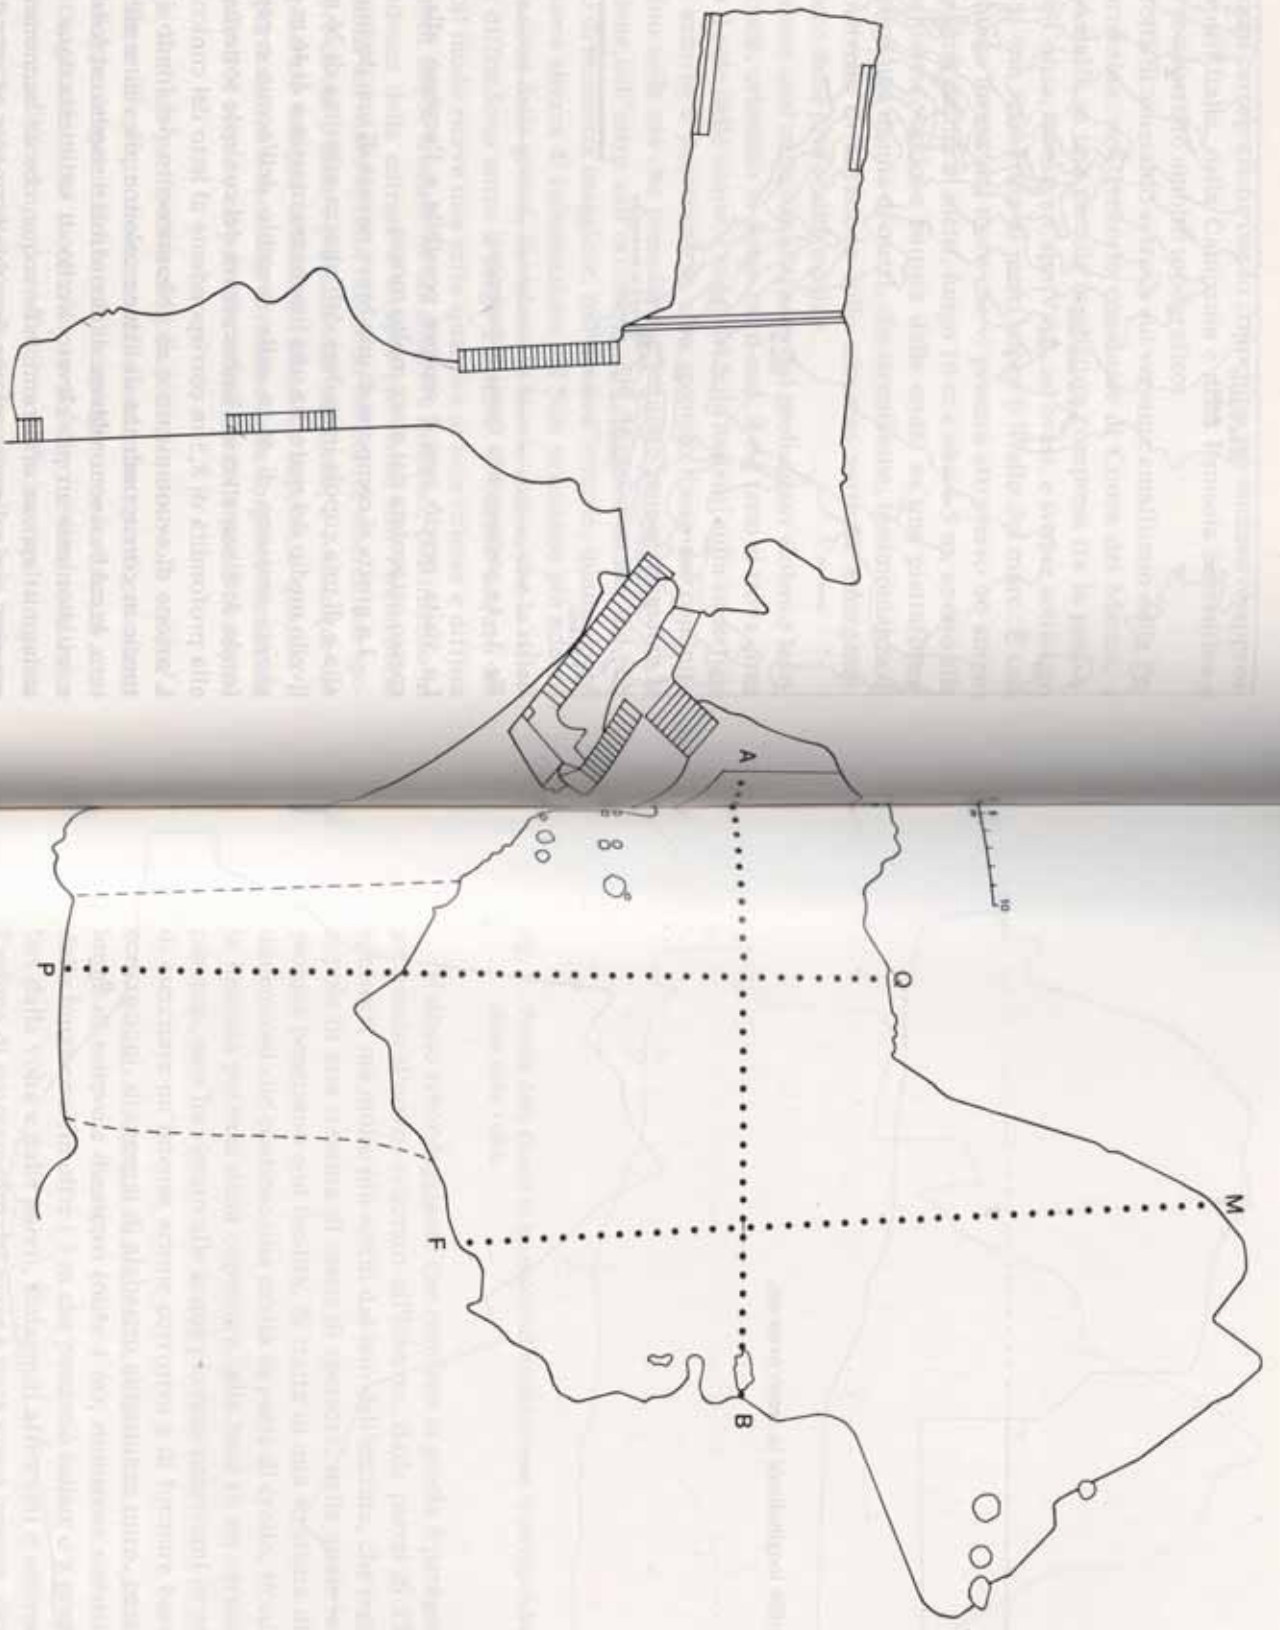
La planimetria della Grotta di Smeraldo e delle strutture AB, QP, MF indicano la disposizione dei profili più significativi.
